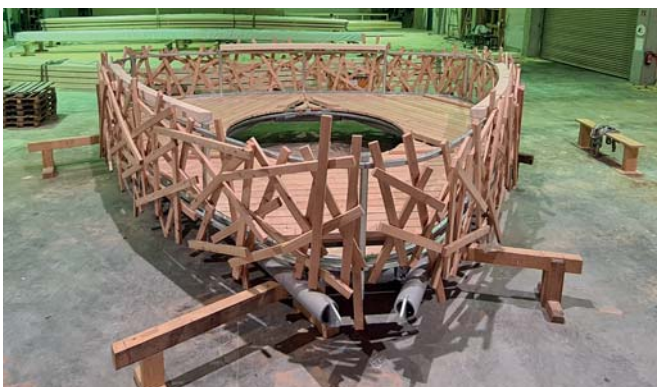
Die Vorfertigung der Nestkonstruktion erfolgte ebenfalls im Werk. Die drei Lagen der scheinbar unregelmäßig verteilten Lärchenholz-Bohlen wurden im 3D-CAD geplant. (Foto: Schaffitzel Holzindustrie)
